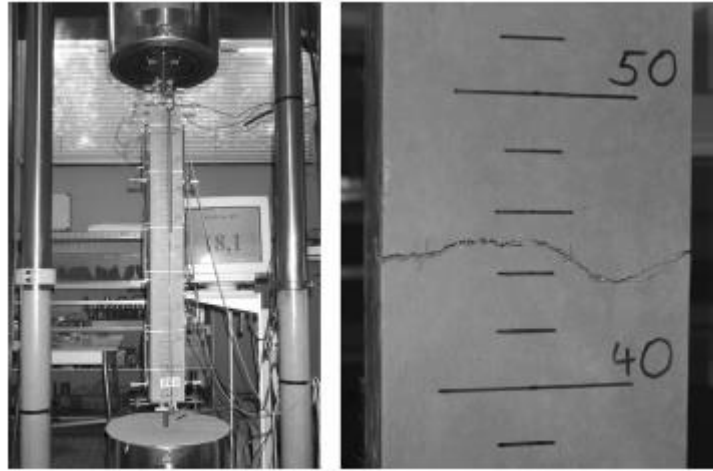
Configuración del Ensayo y detalle de las fisuras. (“Deformation behavior of reinforced UHPFRC tension elements”, V. Sigrist & M. Rauch)
